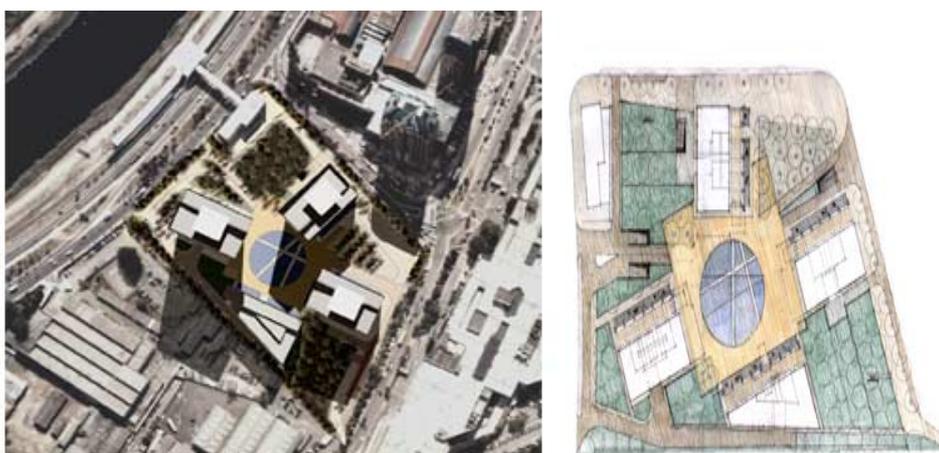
e 60: Market Place Shopping./ Market Place TowerFonte: Carlos Augusto Magalhães (2007)
